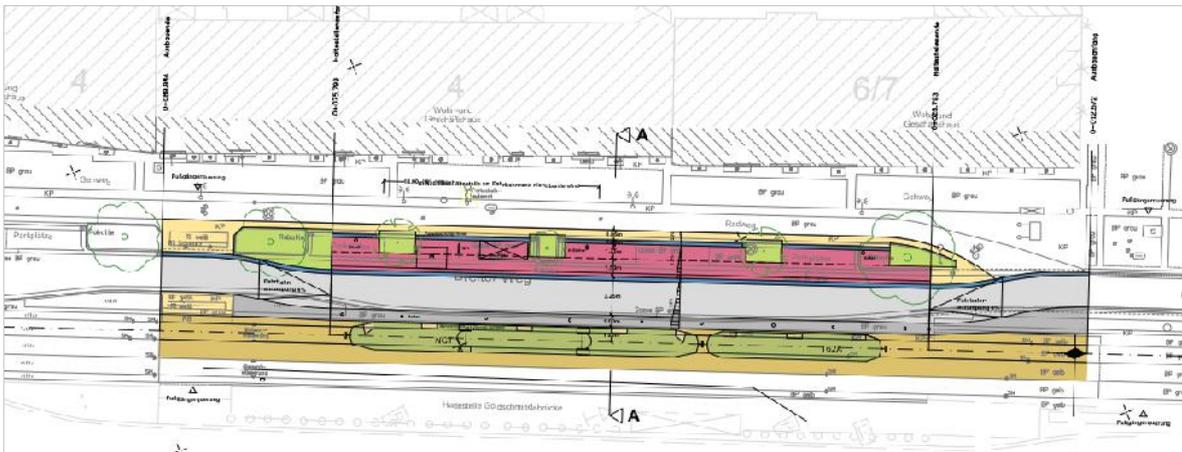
Variante 2 Haltestelle mit angehobener Fahrbahn
